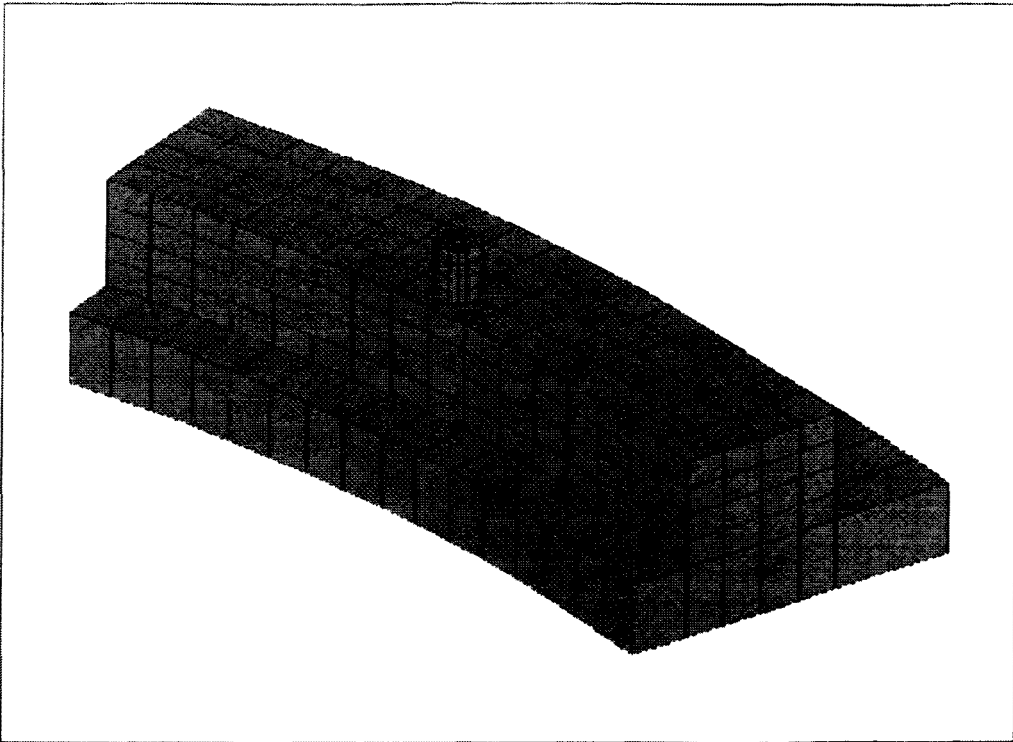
Modellierung eines Fundamentringsektors mit einer Spannschraube mit Volumenelementen (SOLID73)
